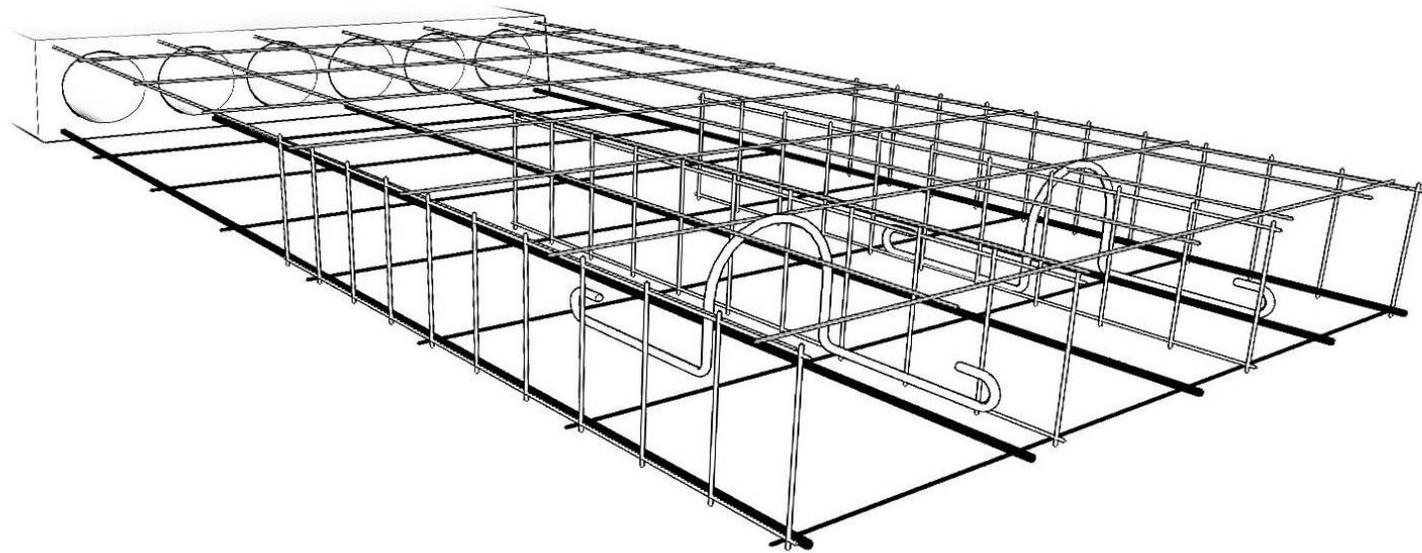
Формы поперечного сечения плит перекрытия (продолжение):
